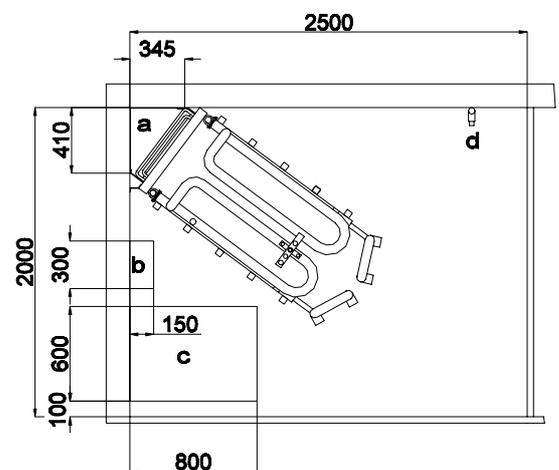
Grundriss einer Bucht in Stallabteil A₁, konventioneller Kastenstand (Maßangaben in mm).
